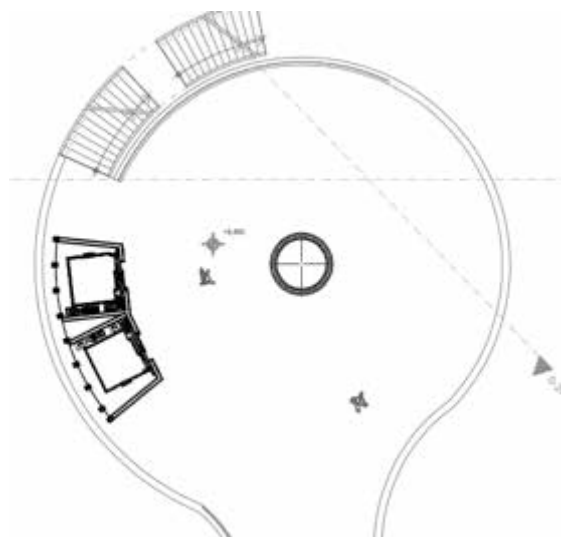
Plaza de acceso 4, planta 2. (+9.45m). (2017)
